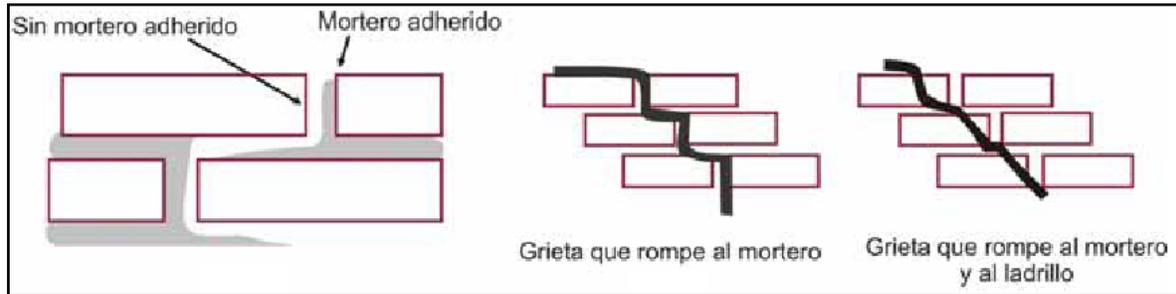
Fallas que se presentan en muros de mampostería. Fuente: Ciser
